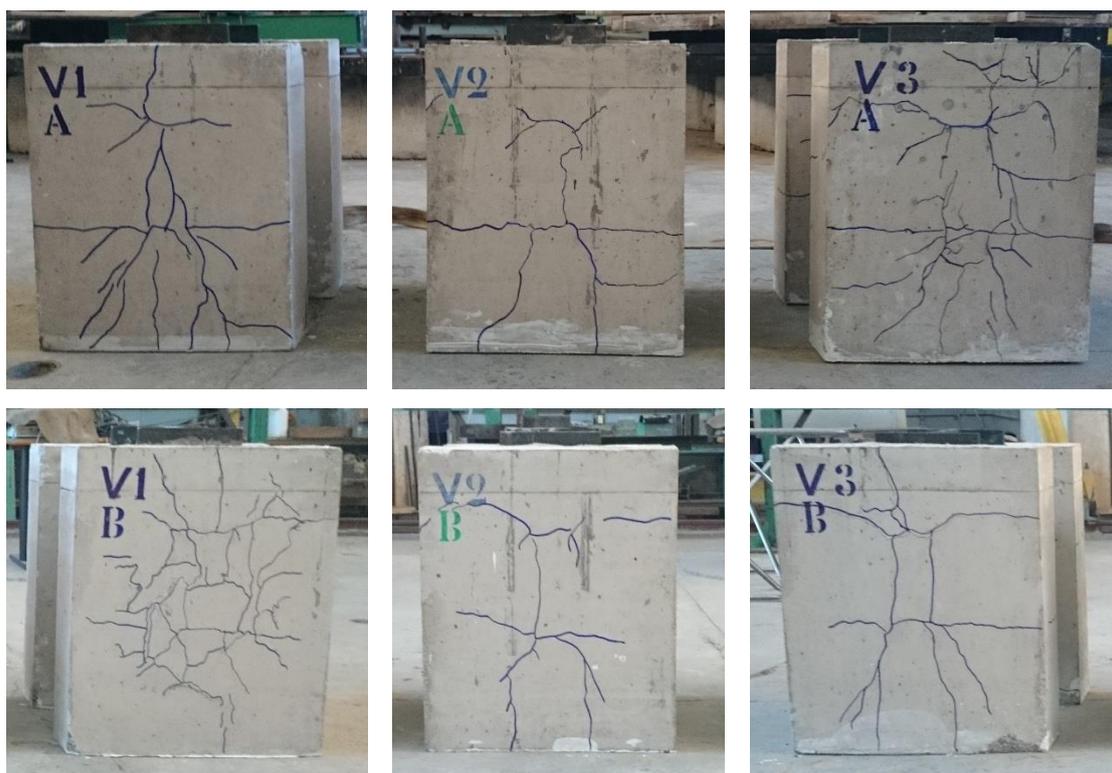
Mapa de fissuras das faces externas das lajes dos modelos.
